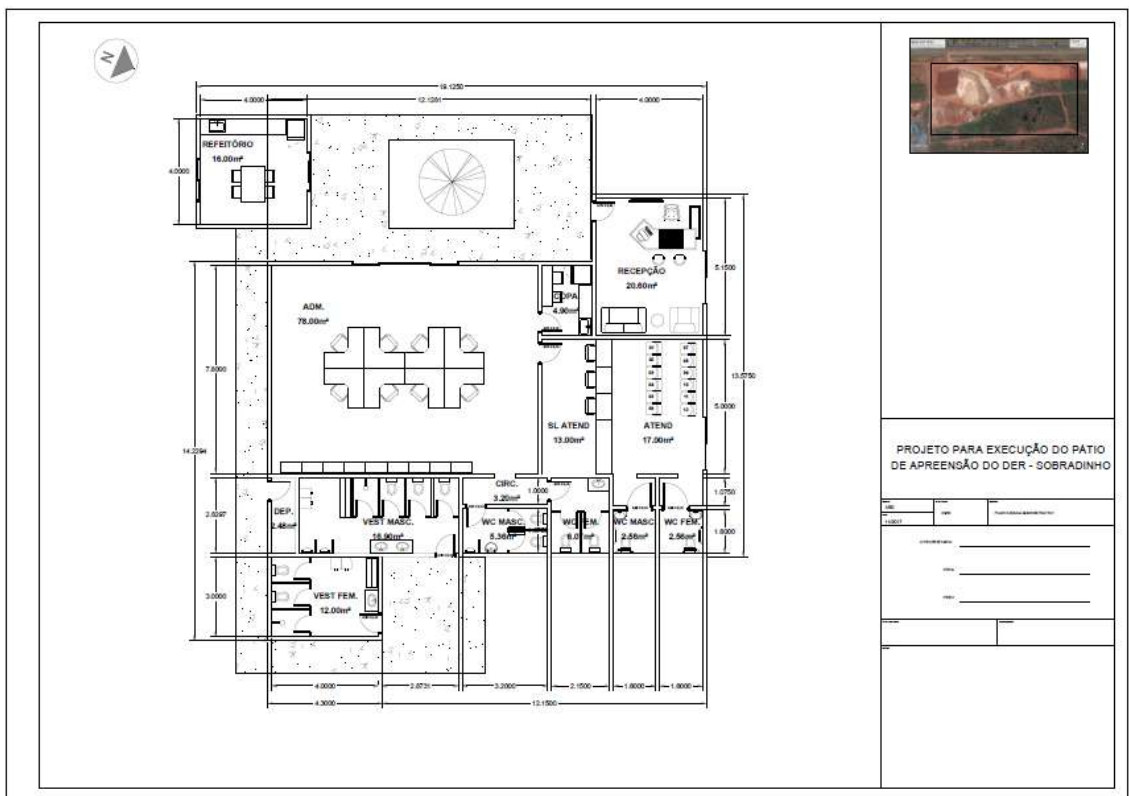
Planta baixa do Prédio ADM do Pátio do Colorado (Fonte: Elaboração própria)
